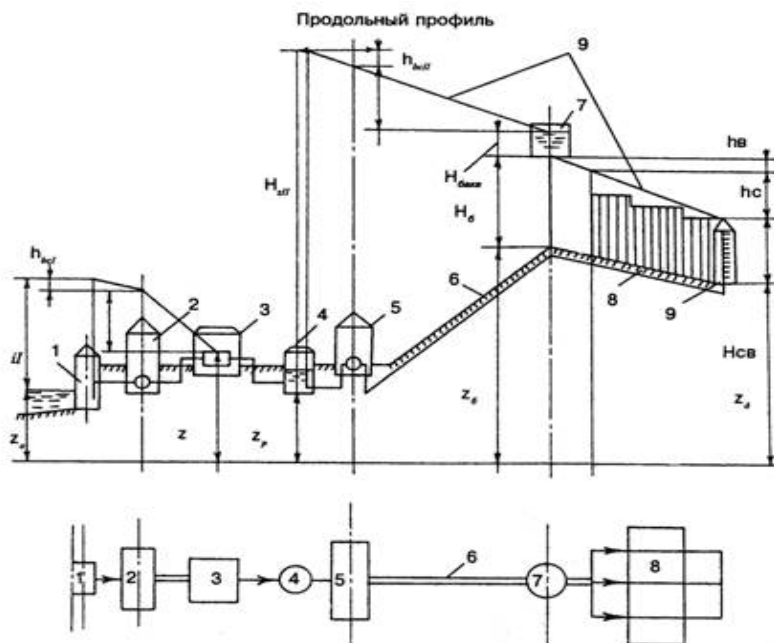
Схема водопостачання з поверхневим джерелом:
